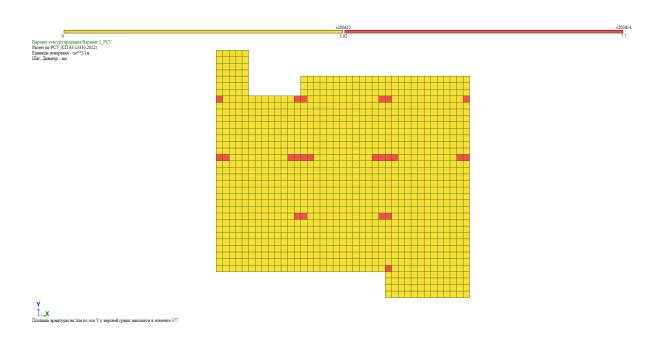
Армирование плиты оси Ү(верхняя зона)
